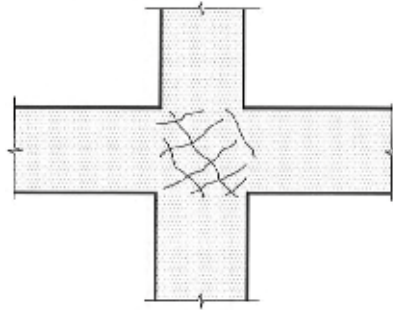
Fisuras en la dirección de las diagonales del nudo (Fuente: Calavera, 2005)
